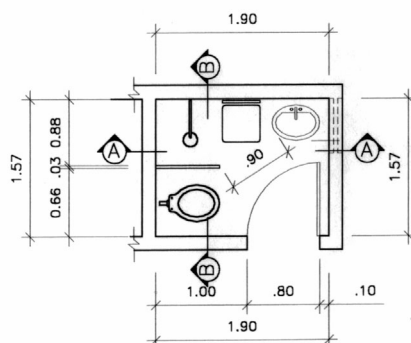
Planta do sanitário adaptado de forma incorreta – pavimento térreo – Escola A
